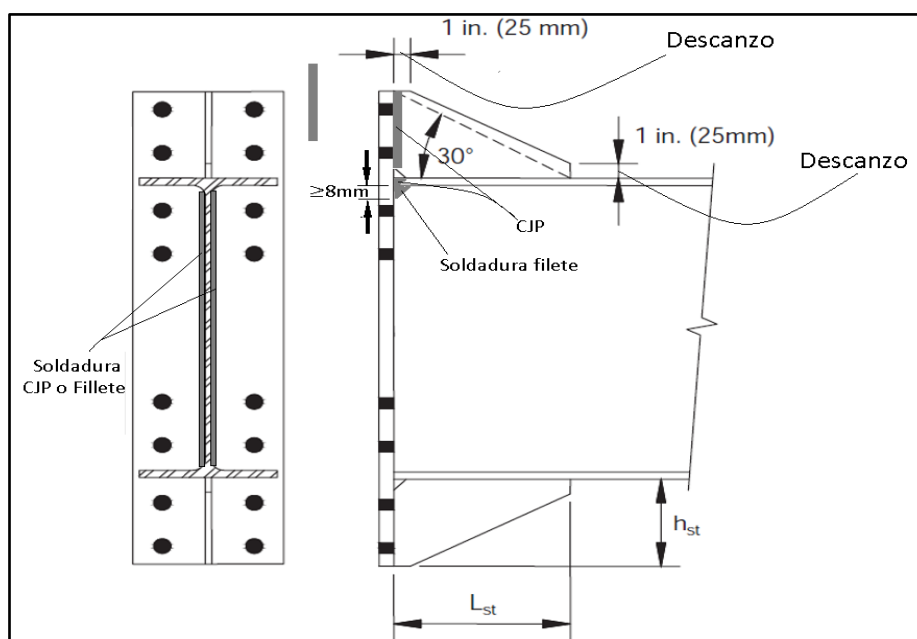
Geometría de placa de extremo extendida reforzada con ocho pernos y detalles de soldadura (8ES). AISC358 (2016)
